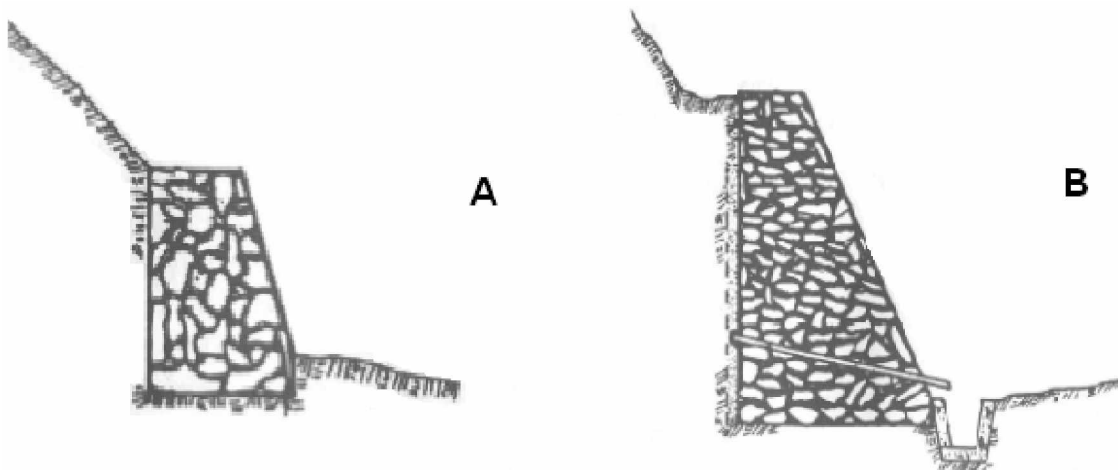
Muros de Gravedad. A) De piedra seca y B) De piedra argamasada.
